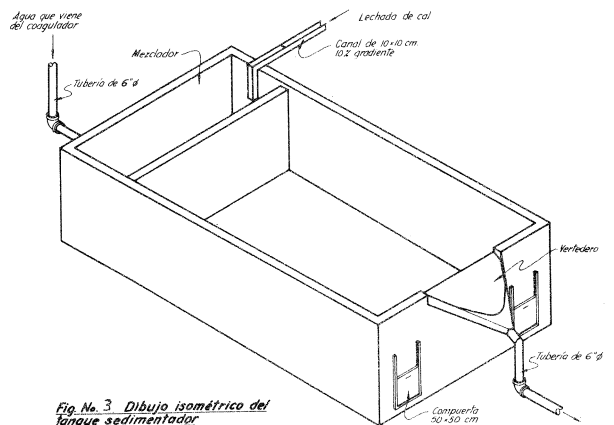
Dibujo isométrico del tanque sedimentador
